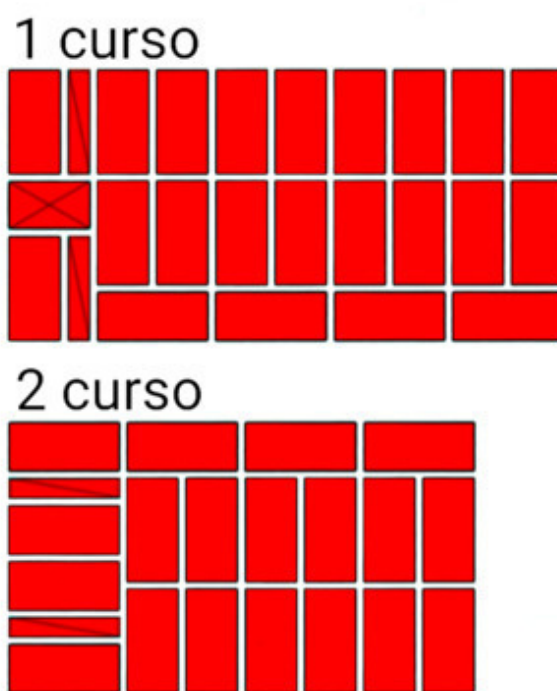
A ordem de colocação de tijolos na restrição vertical da parede de tijolos. Espessura da parede 2,5 tijolos.
